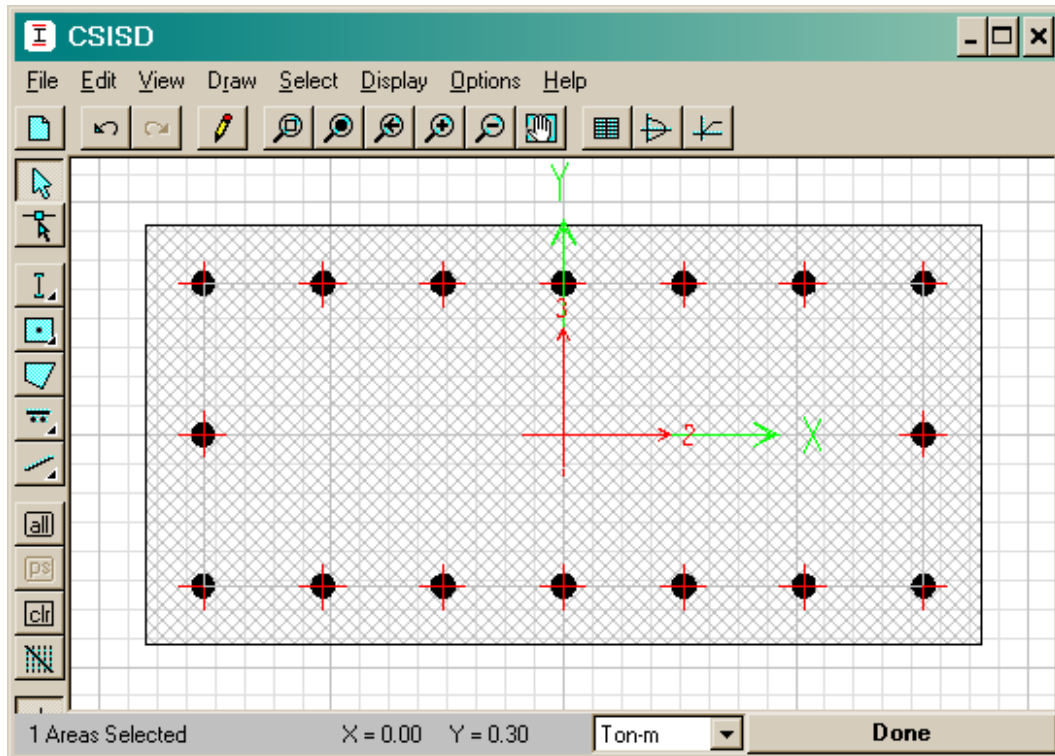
Refuerzo inicial colocado en la columna, dibujado en el Section Designer.
